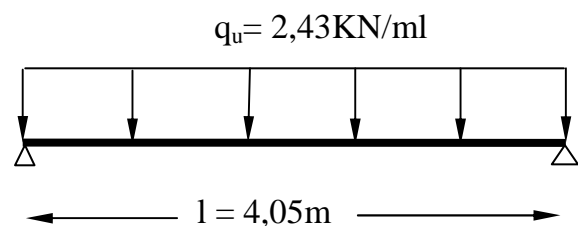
Schéma statique de la poutrelle et son chargement avant coulage de la dalle de
